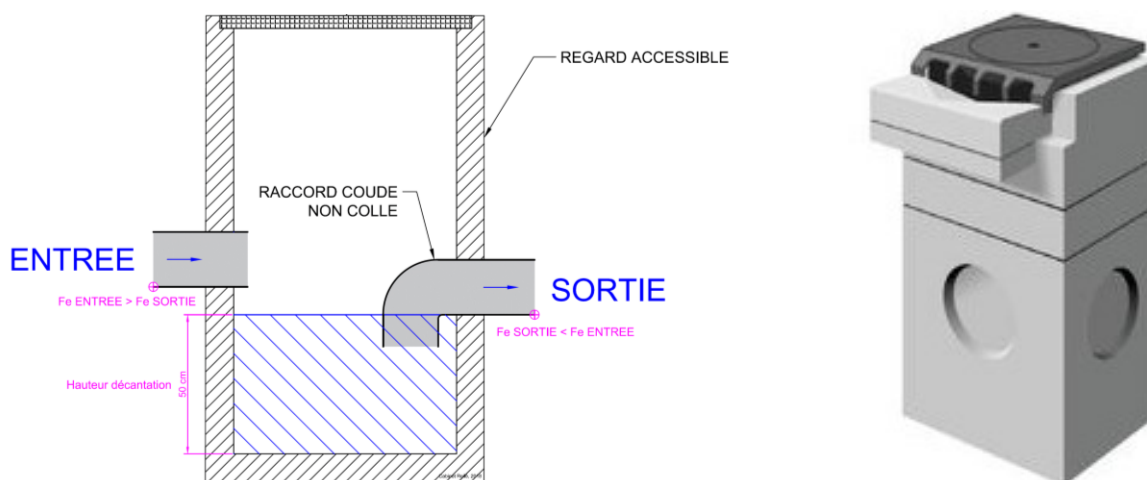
De gauche à droite, plan de principe d'un regard étanche avec décantation (Cabinet Reilé), et photographie d'un avaloir d'égouts avec décantation (POINT.P)
